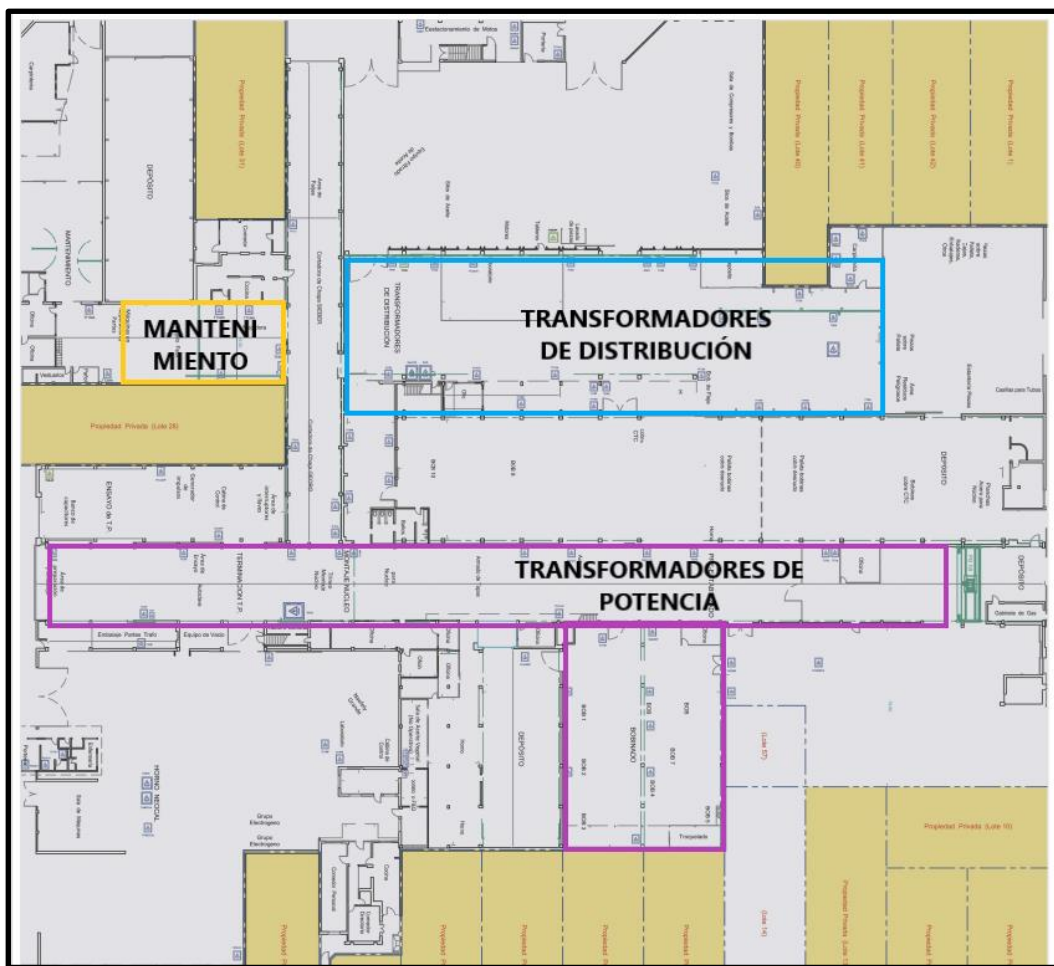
Plano de planta Tubos Trans Electric. Fuente: TTE
